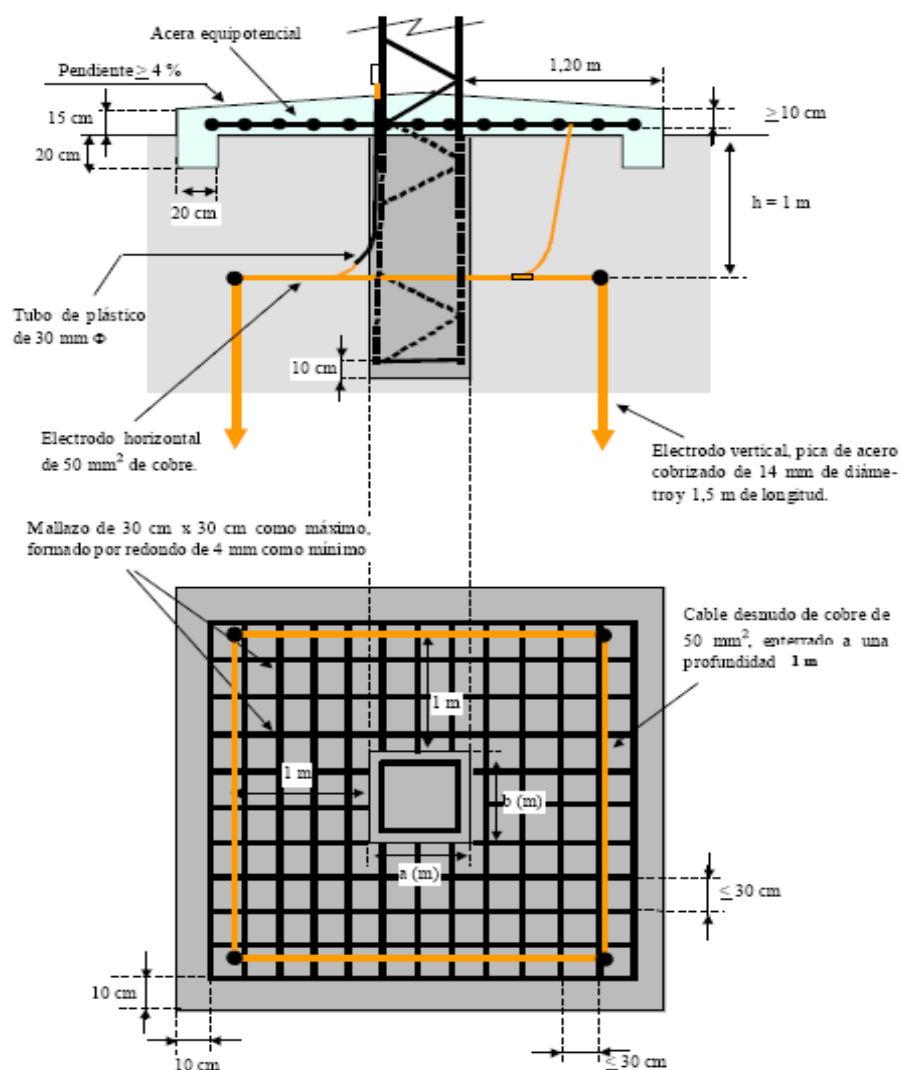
Acera de hormigón, con mallazo equipotencial, perimetral con la cimentación del apoyo, empleado en líneas aéreas con apoyos frecuentados sin calzado.
